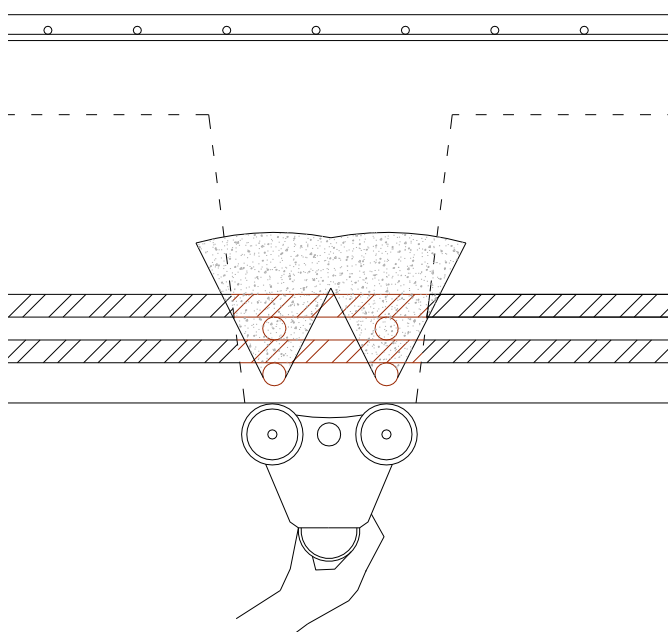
Corte AB – Ensaio Ferroskan na face inferior.
